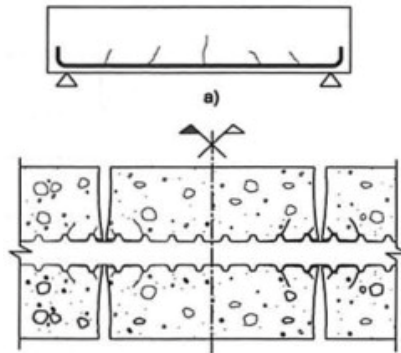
Fisuras por alargamiento de la armadura (Fuente: Calavera, 2005)
